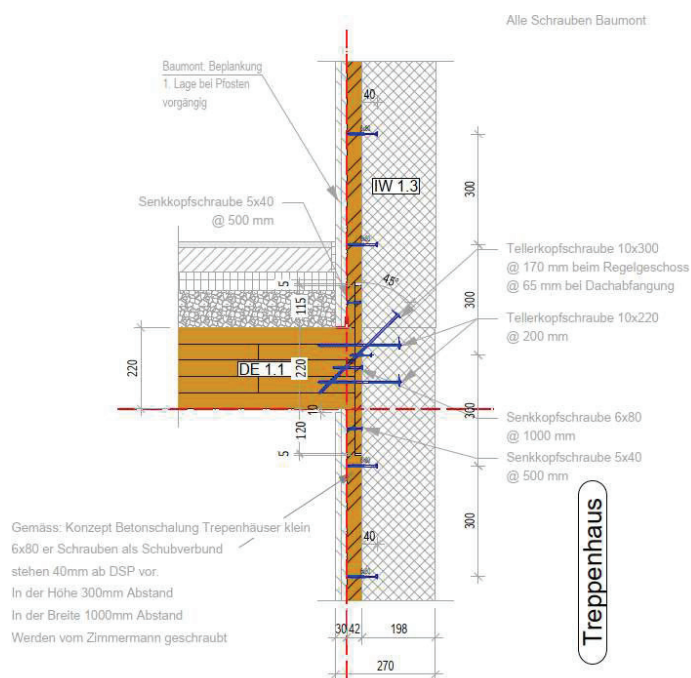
Anschlussdetail des Deckenauftragers am Treppenhauskern,
